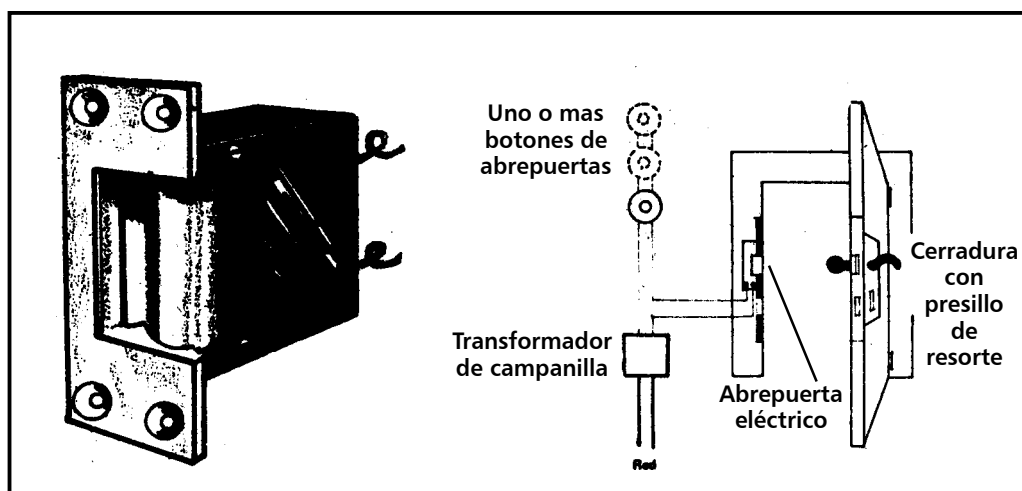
Aspecto físico y montaje de una cerradura eléctrica.
